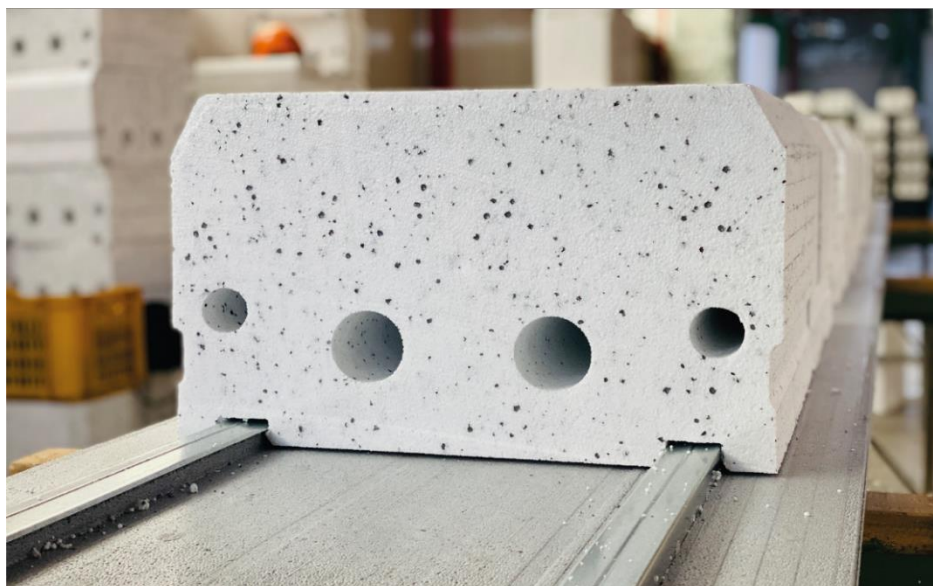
Particolare del Cassero Cube® - Elemento di alleggerimento e aletta di coibentazione.
